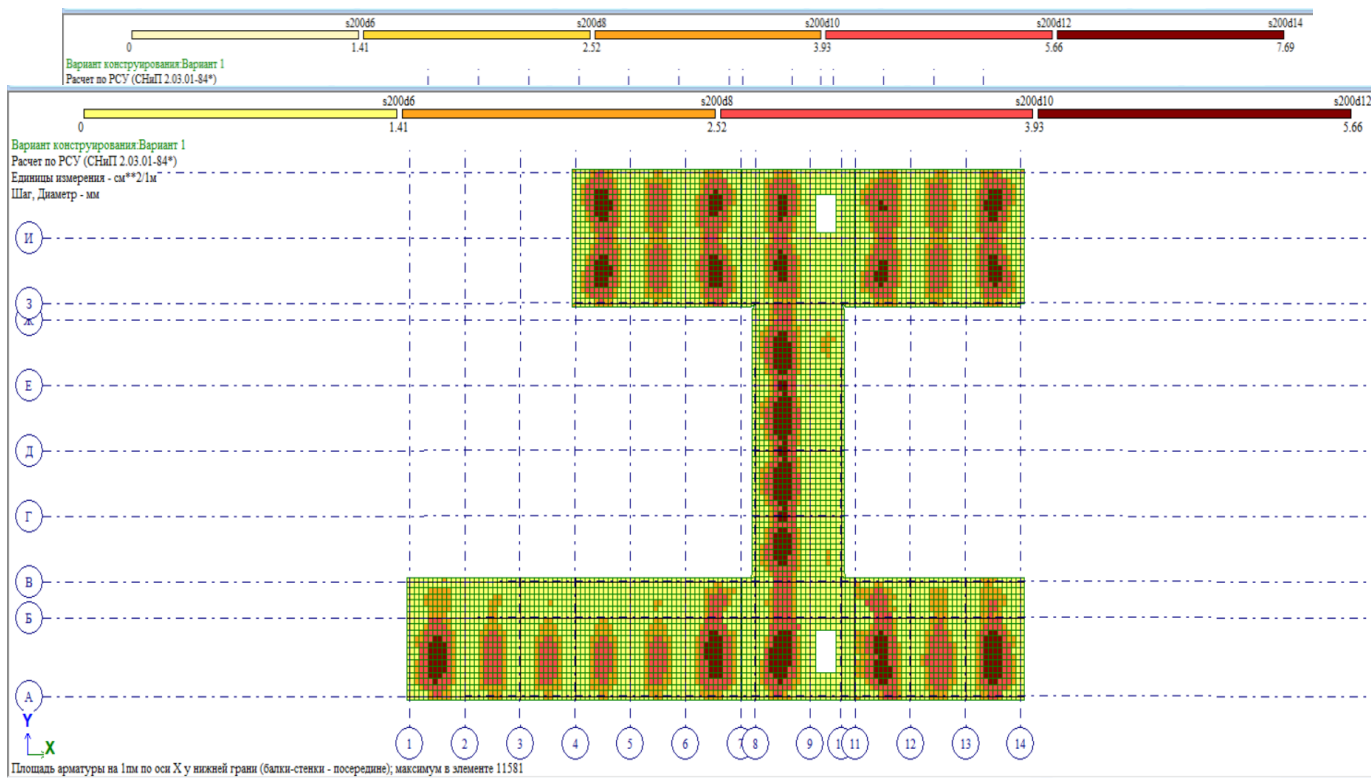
Площадь арматуры по оси У у нижней грани в перекрытии
